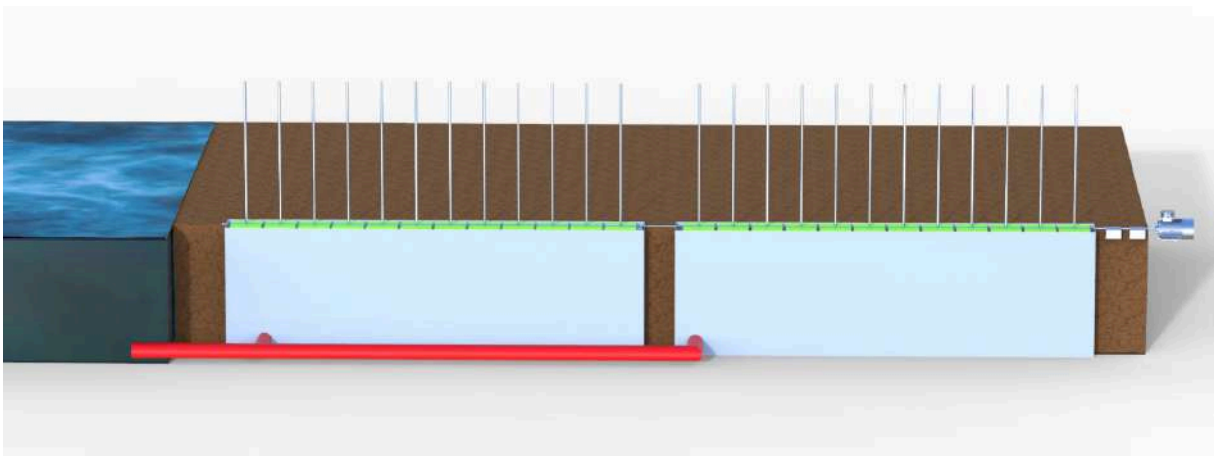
Vista frontal de piletones en 3D Fuente: elaboración del autor
